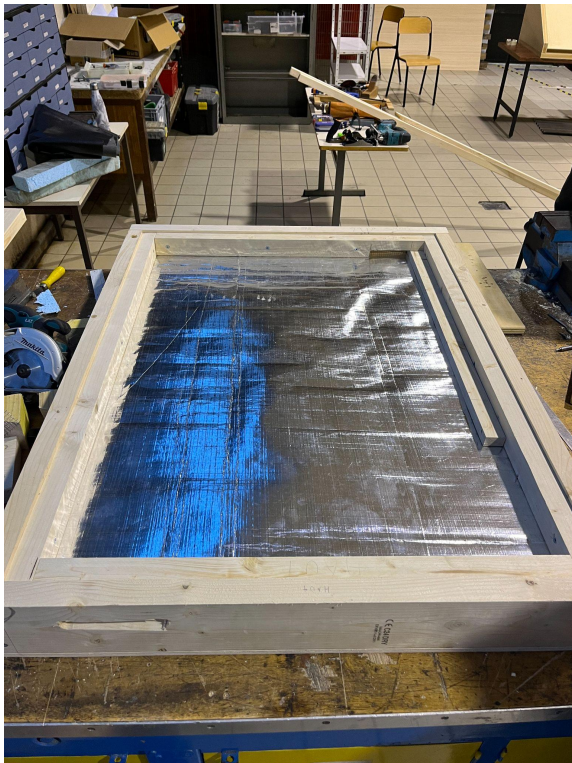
A: Panneau d'aluminium réfléchissant, vue de face
